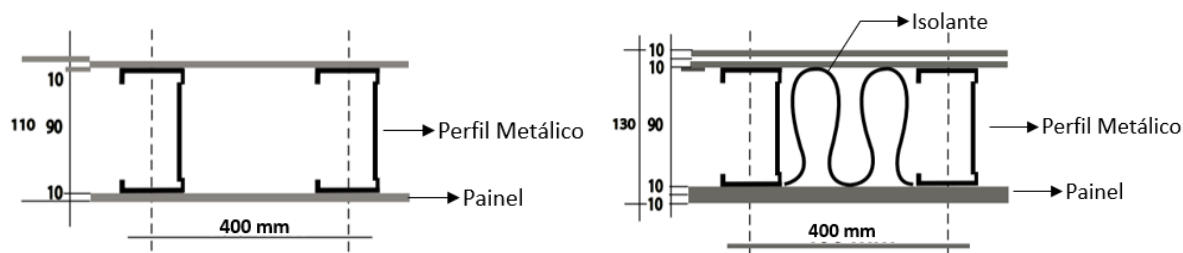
Painéis metálicos para TRRF 30 e 120 min
